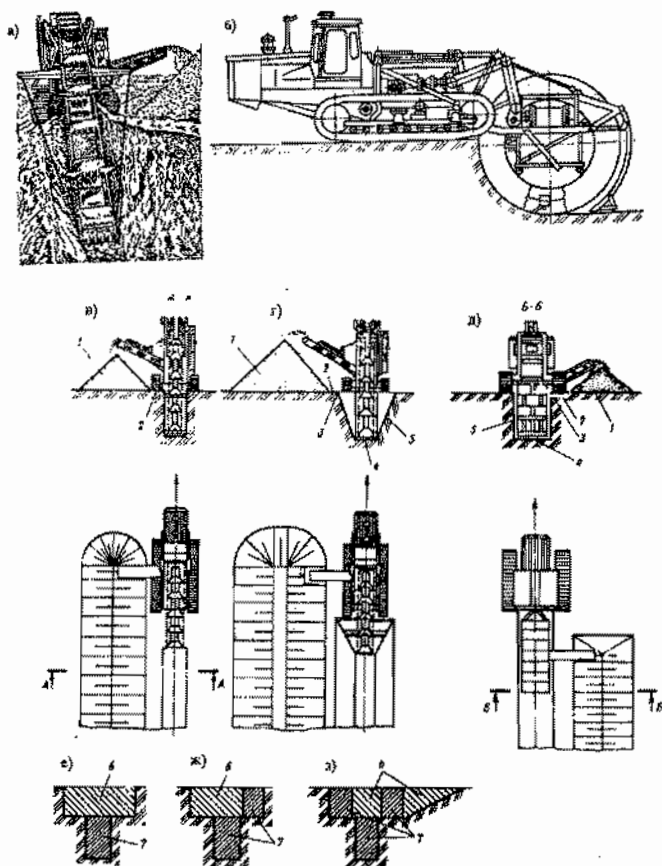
Схемы разработки грунта при отрывке траншей многоковшовыми экскаваторами: а, г - цепными с откосообразователями; в - цепным; б, д - роторным; е, ж, з - комбинированные способы разработки глубоких траншей роторными экскаваторами и бульдозерами; 1 - отвал грунта; 2 - берма траншеи; 3 - бровка; 4 - дно траншеи; 5 - стенки траншеи; 6 - части траншеи, разрабатываемые бульдозером; 7 - то же, роторным экскаватором
